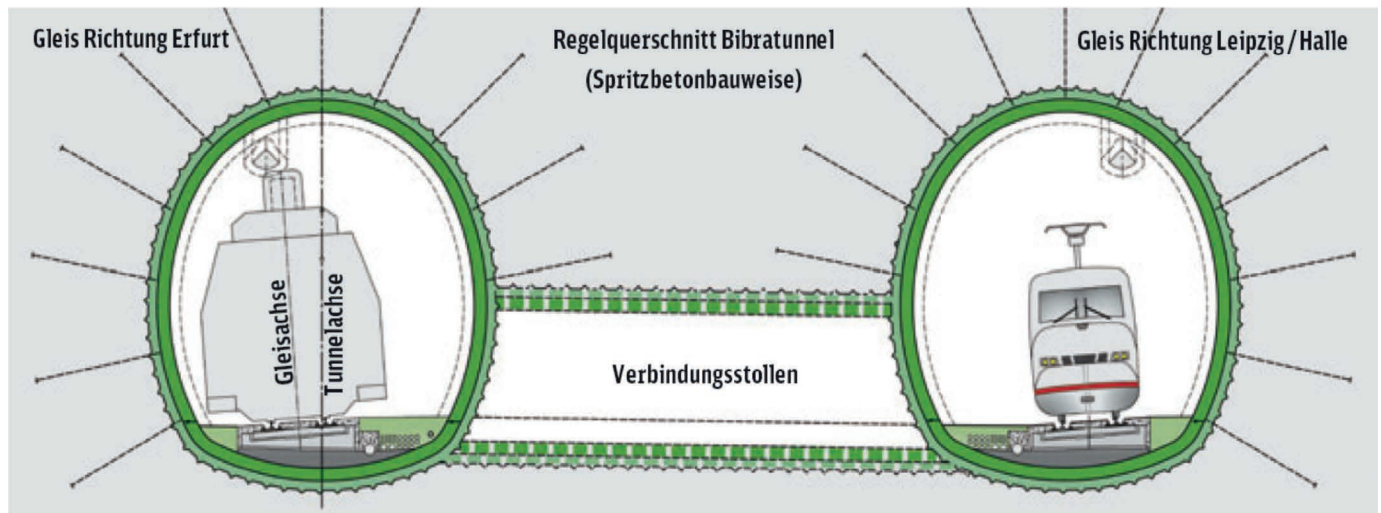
Tunnelsystem im Projekt VDE 8.2 (Erfurt–Halle/Leipzig) mit zwei Einspurtunneln (Grafik: DB AG)
